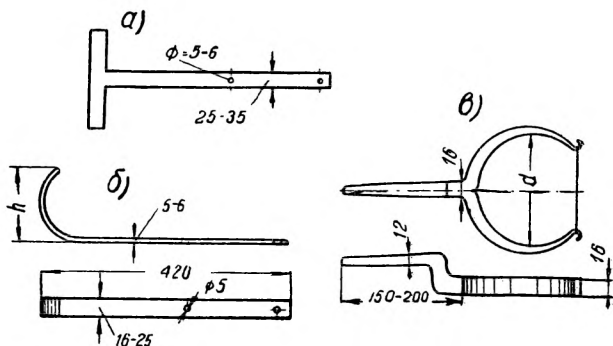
Материалы для крепления карнизного свеса, настенных желобов и водосточных труб:
